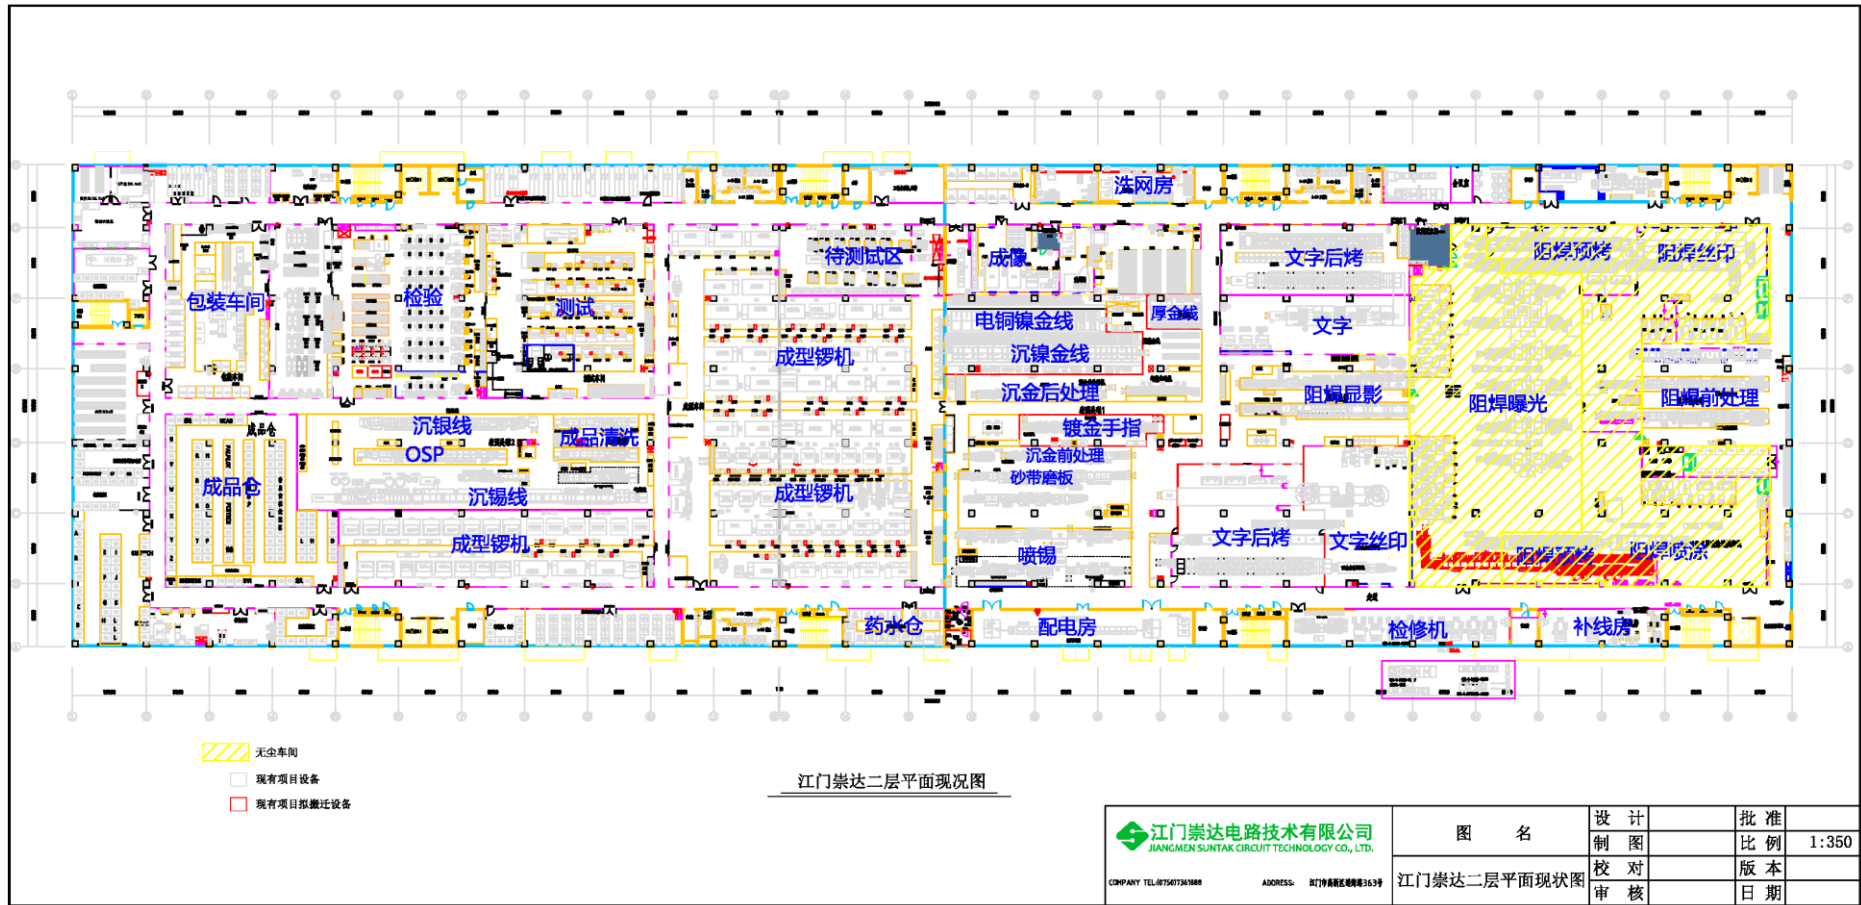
(b) 现有项目厂房一 2F 车间平面布置图
